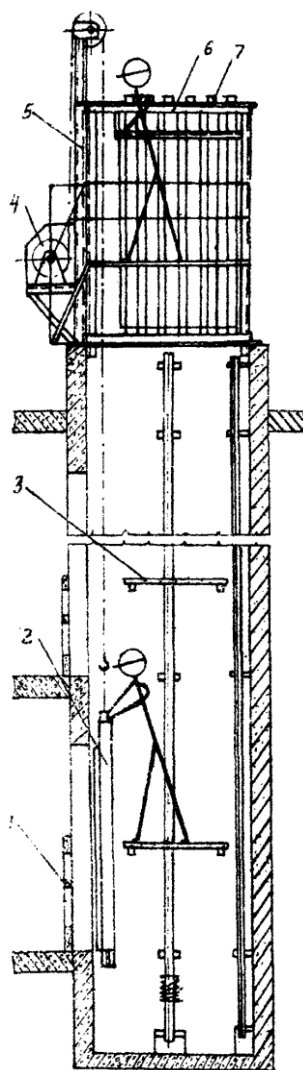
Монтаж дверей шахты с контейнера, оборудованного грузоподъемным устройством;
